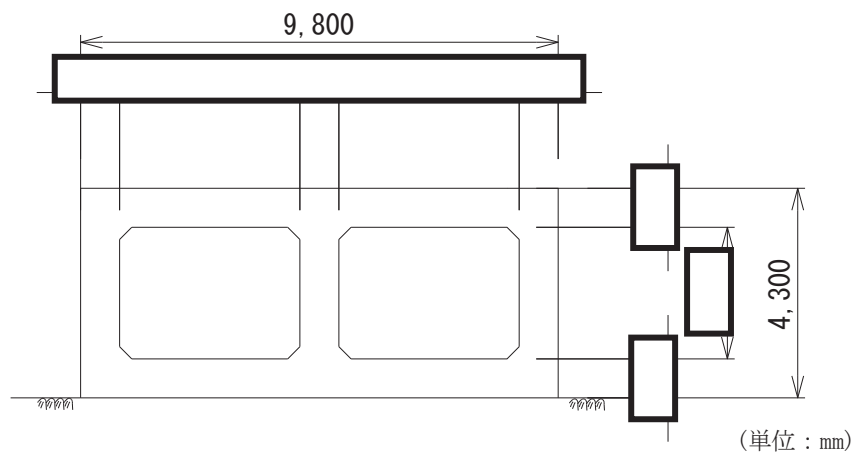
(1) 第1号機取水路の断面図 (A-A断面)
